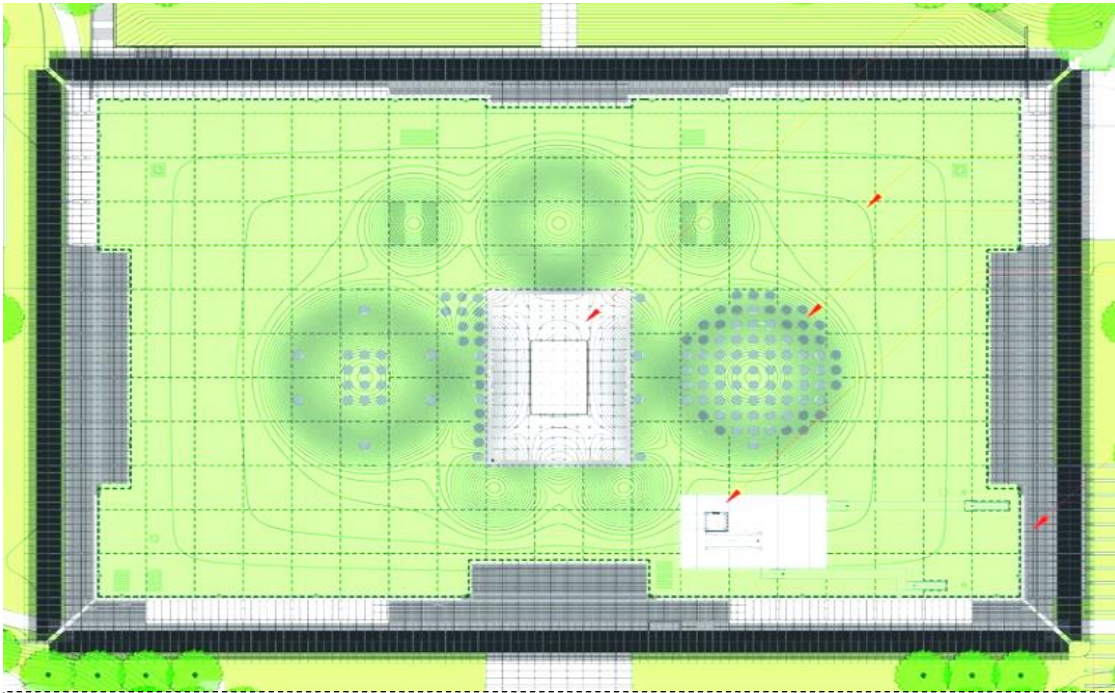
Plan de Toiture, Source : <http://www.actuarchi.com>
